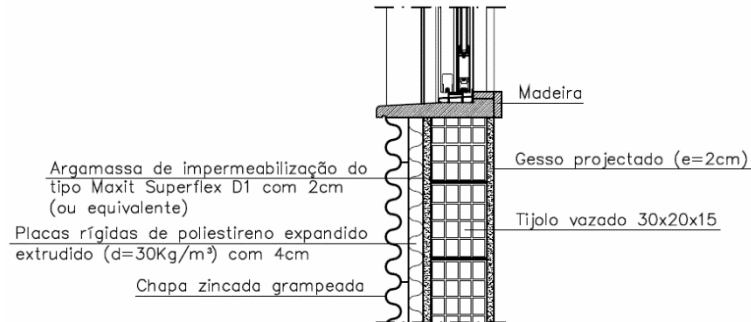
Pormenor construtivo da Parede Exterior - Pe2
